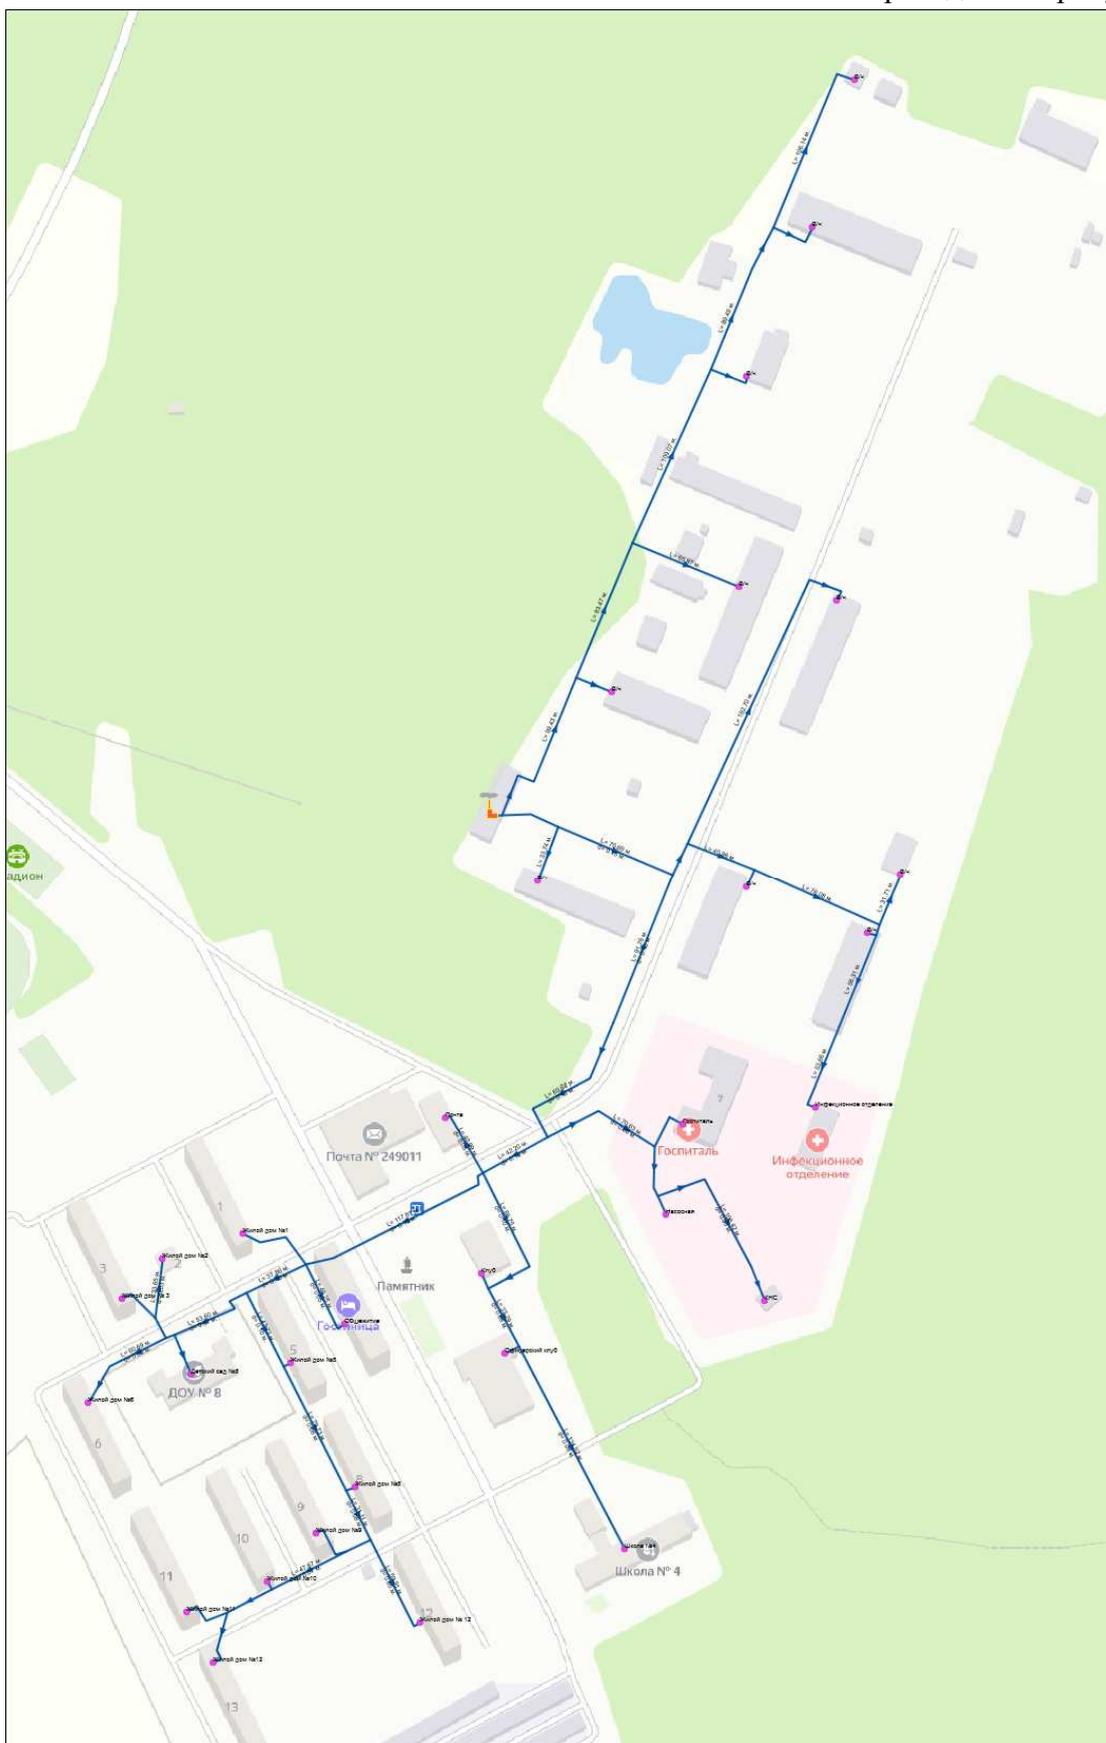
Схема тепловых сетей зоны теплоснабжения котельной №105
